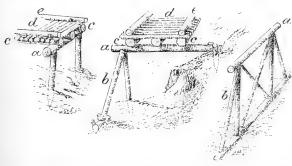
Construction für einsache Waldwege. a Jochbrehling (Hold), b Streben, c Streckbaume, d Fahrbahn mit ben Fahrbahnhölsgern, 6 Streifbaume.
